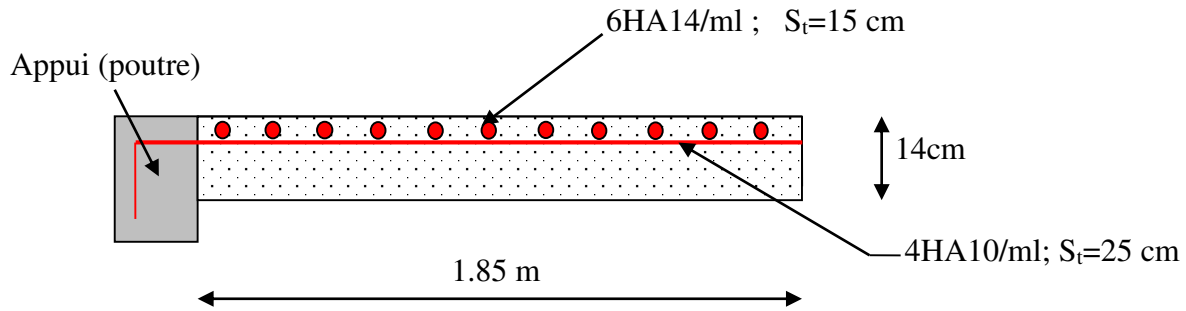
Schéma de ferrailage de la dalle sur 3 appuis.
